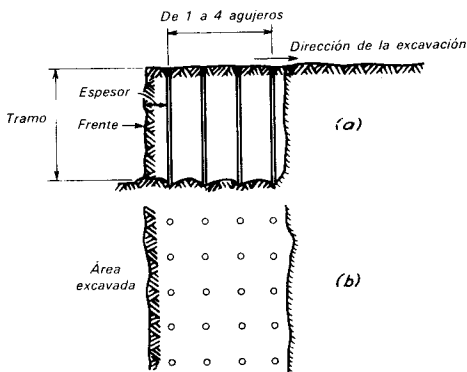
Distribución típica de barrenación para eliminar un crestón de roca en la excavación de una cimentación. a) Sección transversal. b) Planta.
